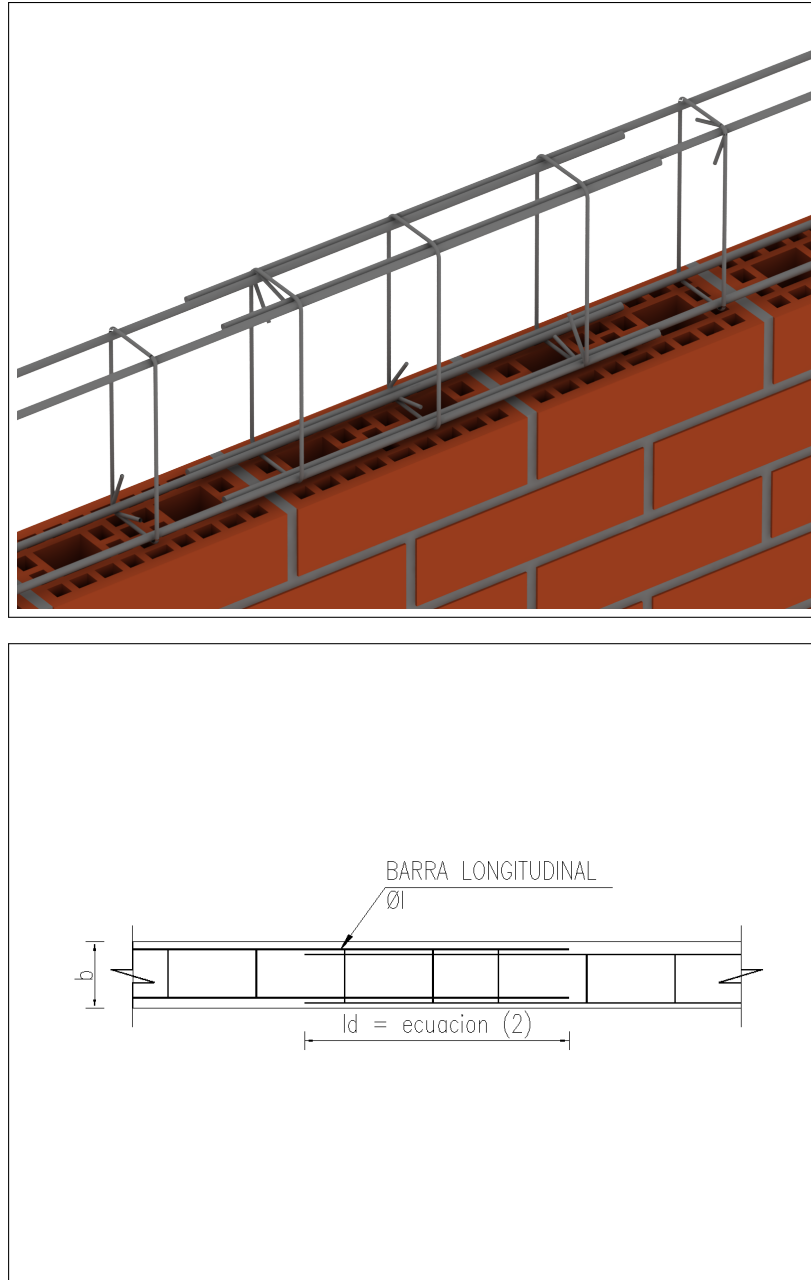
Detalle de empalme de barras longitudinales de cadenas y pilares de confinamiento
